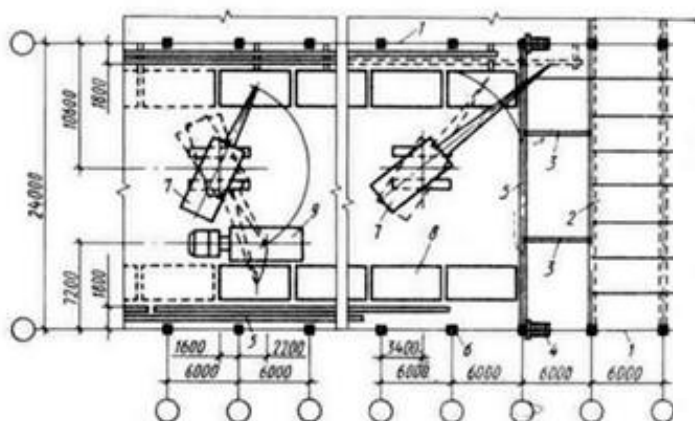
Схема выгрузки, раскладки элементов и монтажа покрытия пролетом 24 м, с шагом колонн и ферм 6 м продольным методом: 1 – временное ограждение; 2 – смонтированное покрытие; 3 – инвентарная распорка для временного крепления ферм; 4 – лестница-площадка приставная; 5 – стропильная ферма; 6 – колонна; 7 – кран; 8 – штабель плит; 9 – транспортное средство.
